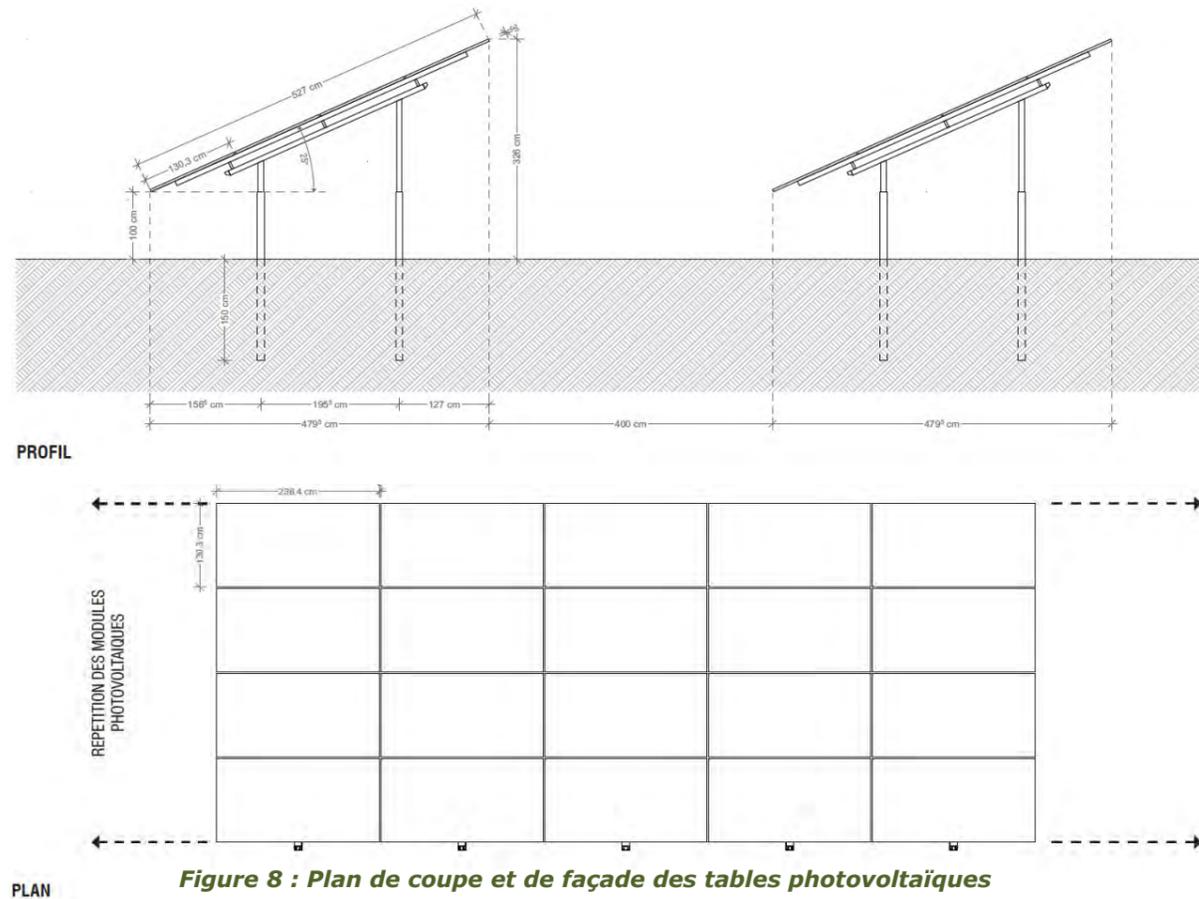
Plan de coupe et de façade des tables photovoltaïques
